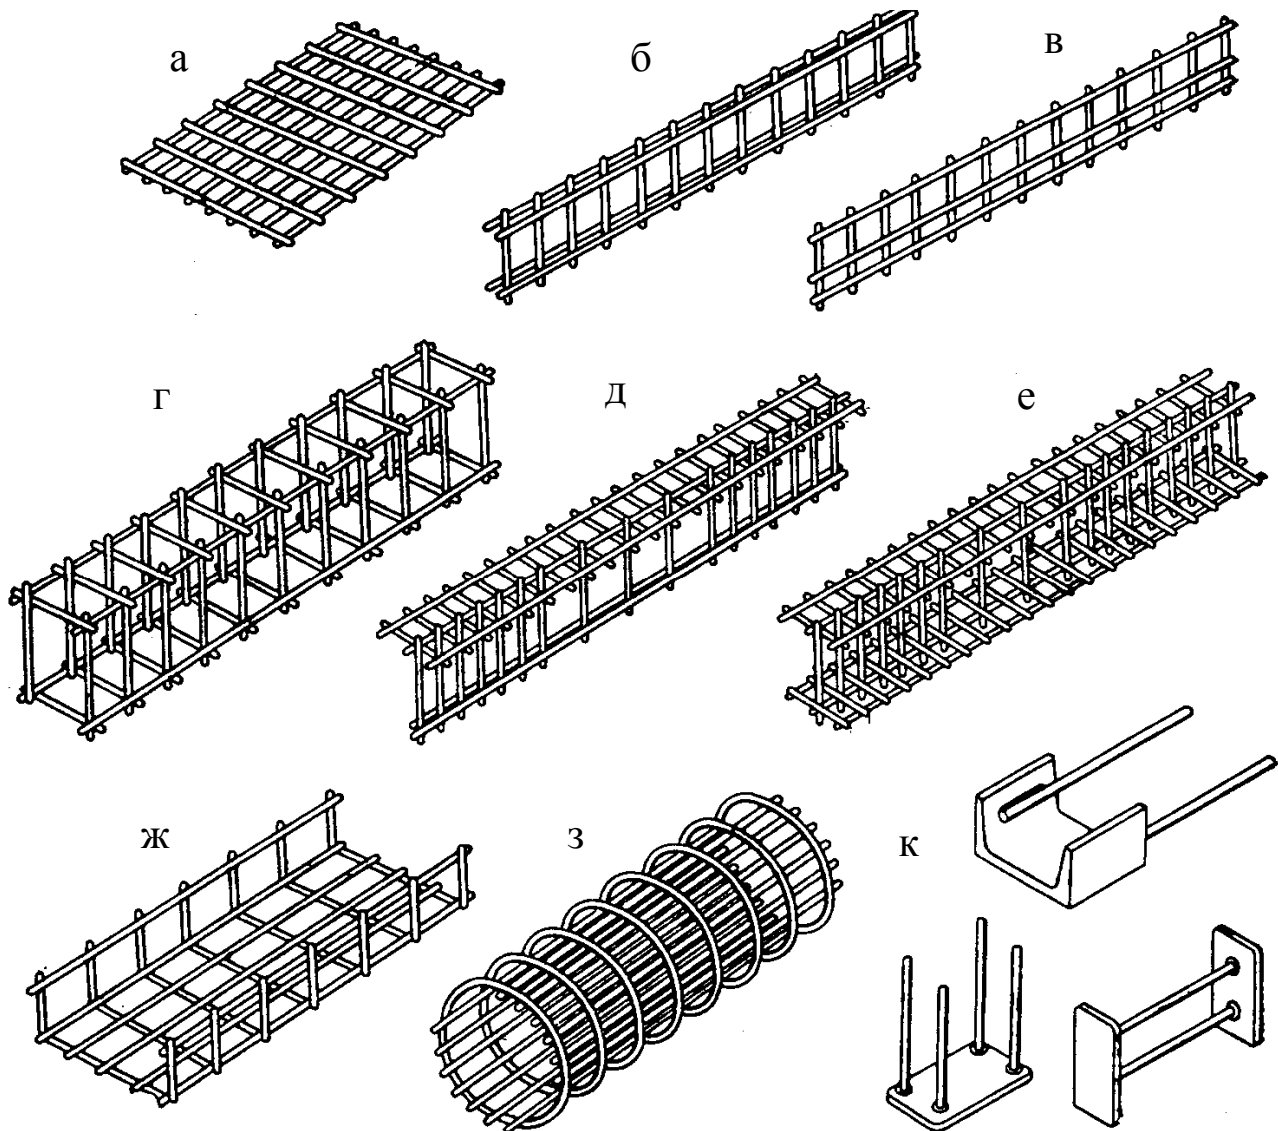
Різновиди арматурних виробів: а – плоска сітка; б, в – плоскі каркаси; г – просторовий каркас; д – просторовий каркас із тавровим перерізом; е – те саме, із двотавровим перерізом; ж – гнута сітка; з – те саме, із криволінійним перерізом; к – закладні деталі
